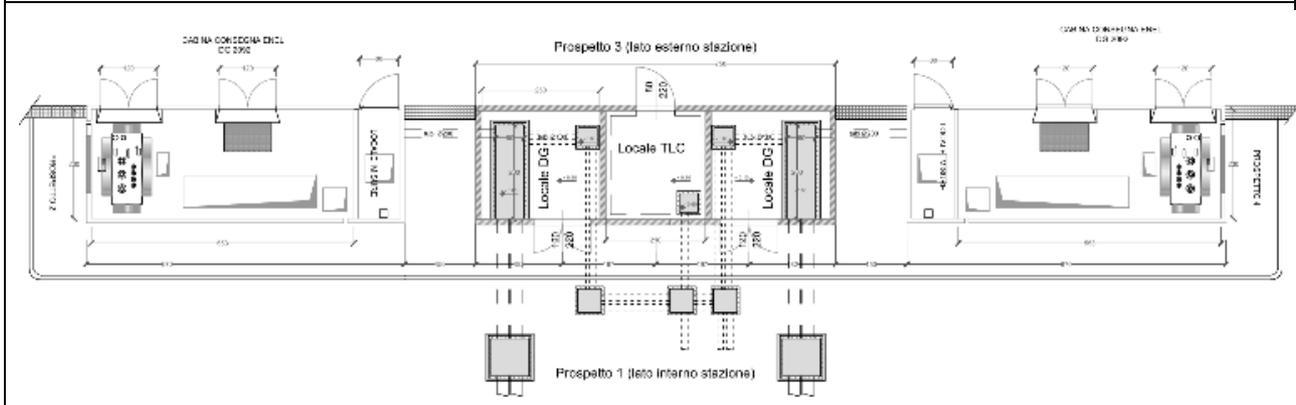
Planimetria edificio Consegna servizi esterni (estratto da progetto, elaborato: G855_DEF_R_005_Rel_tec_SE_1-1_REV00)
